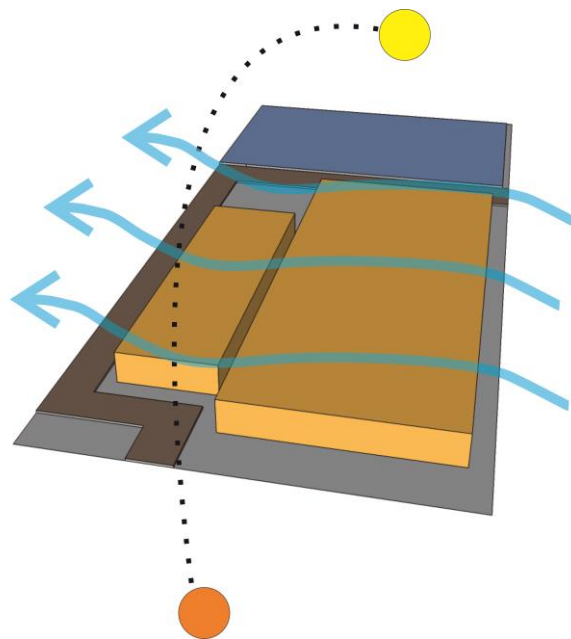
28 Konsep Massa dan penerapan jalur sirkulasi baru
